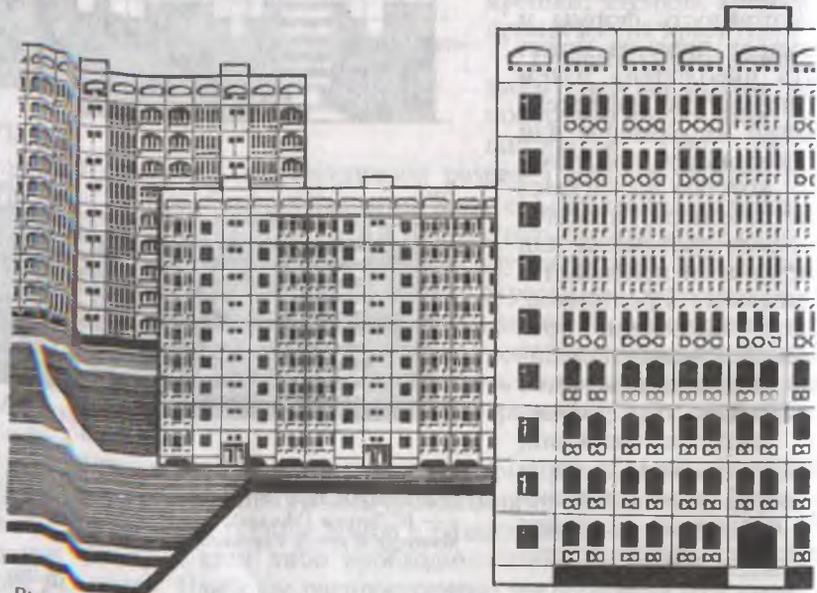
Солнцезащитные бетонные решетки на фасадах домов (г. Ташкент)
